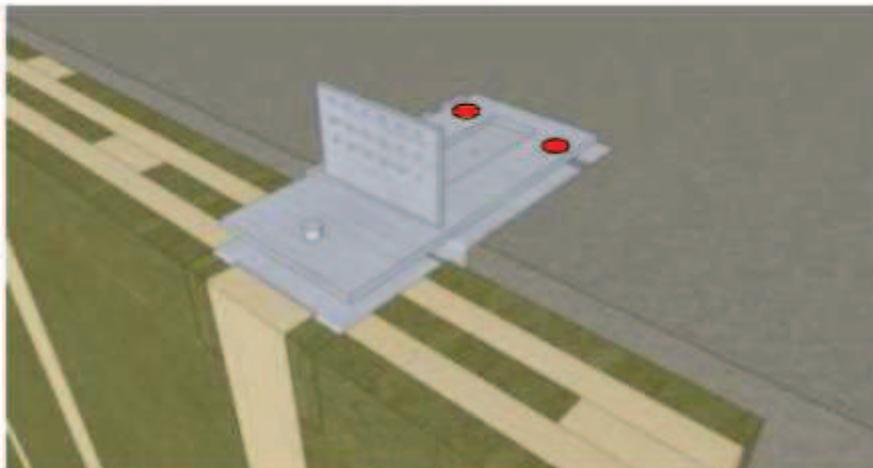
Fixation définitive de u plat de liaison à la dalle par goujons d'ancrage
